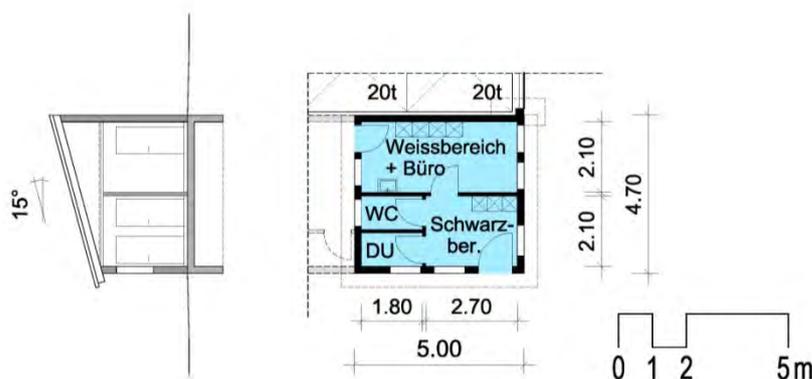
Grundriss und Schnitt der Hygieneschleuse
